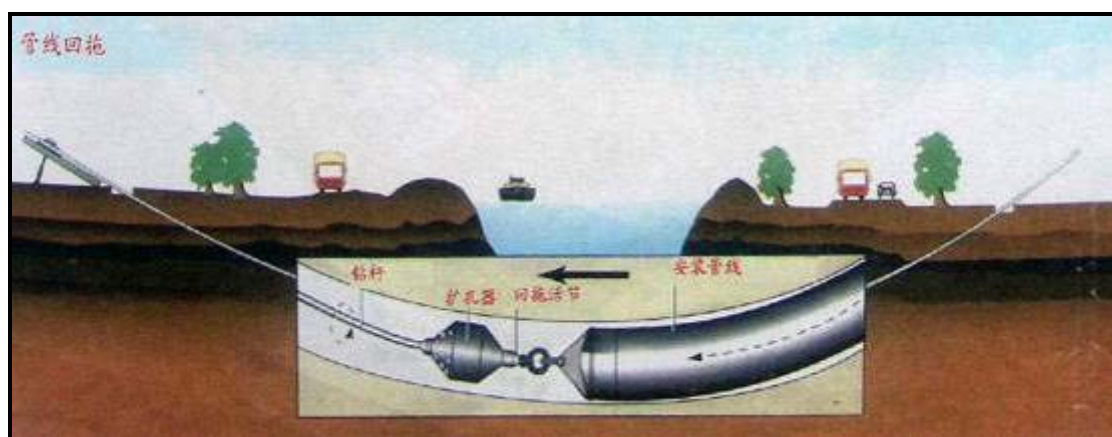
定向钻穿越施工管线回拖过程断面示意图
